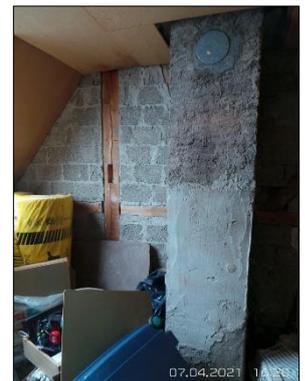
18 Räume im 2. OG; Dachterrasse
